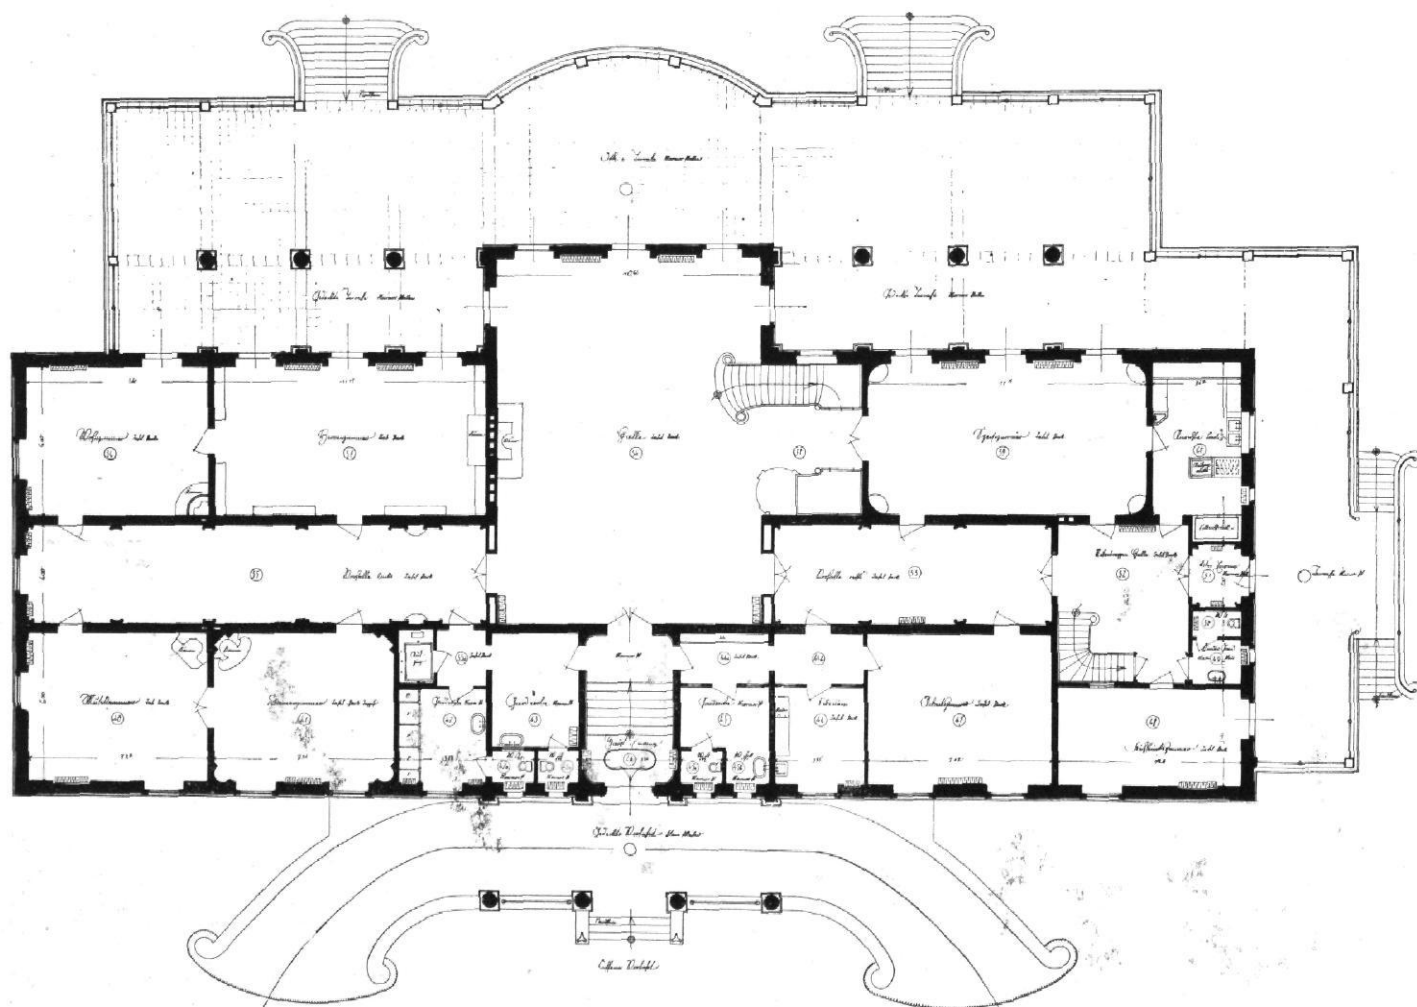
/ Herrenhaus Hobeorst / Architekt: Otto Blendermann, Bremen / Grundriß des Erdgeschosses 1: 300
